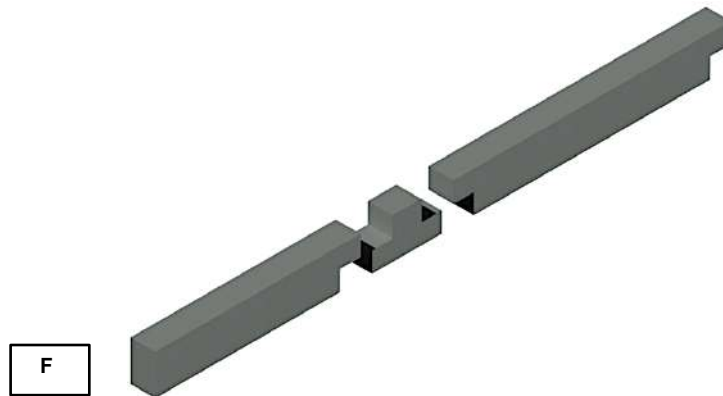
Viga pré-moldada GERBER. Fonte: autoral
